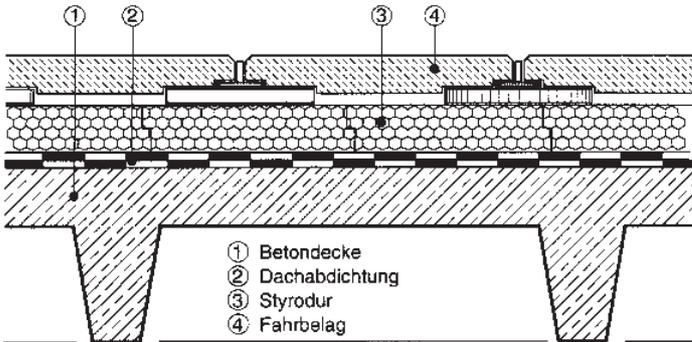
Parkdach als Umkehrdach mit aufgestellten Betonplatten
